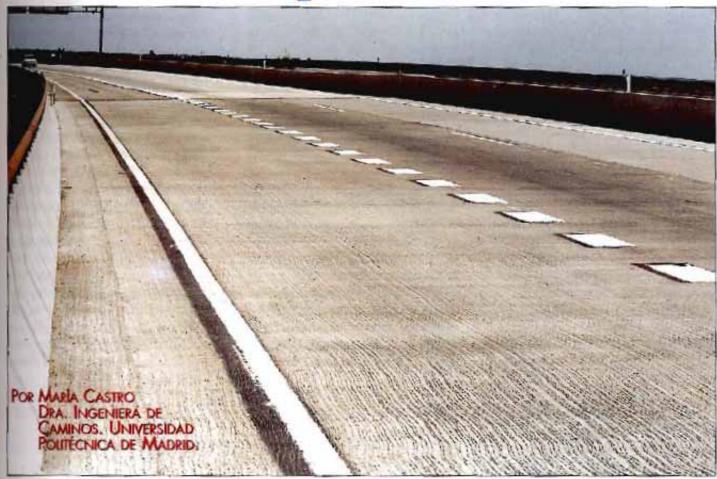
Pavimento de hormigón adherido sobre una de las estructuras de la camante de Arganda.
